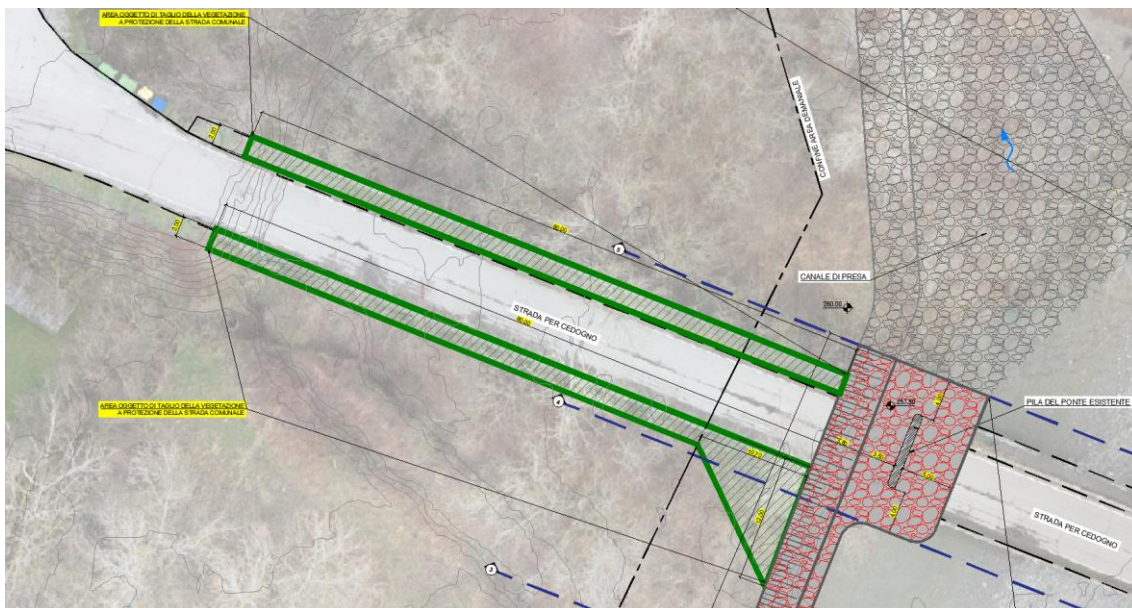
Stralcio planimetrico con indicate in verde le aree di taglio della vegetazione
